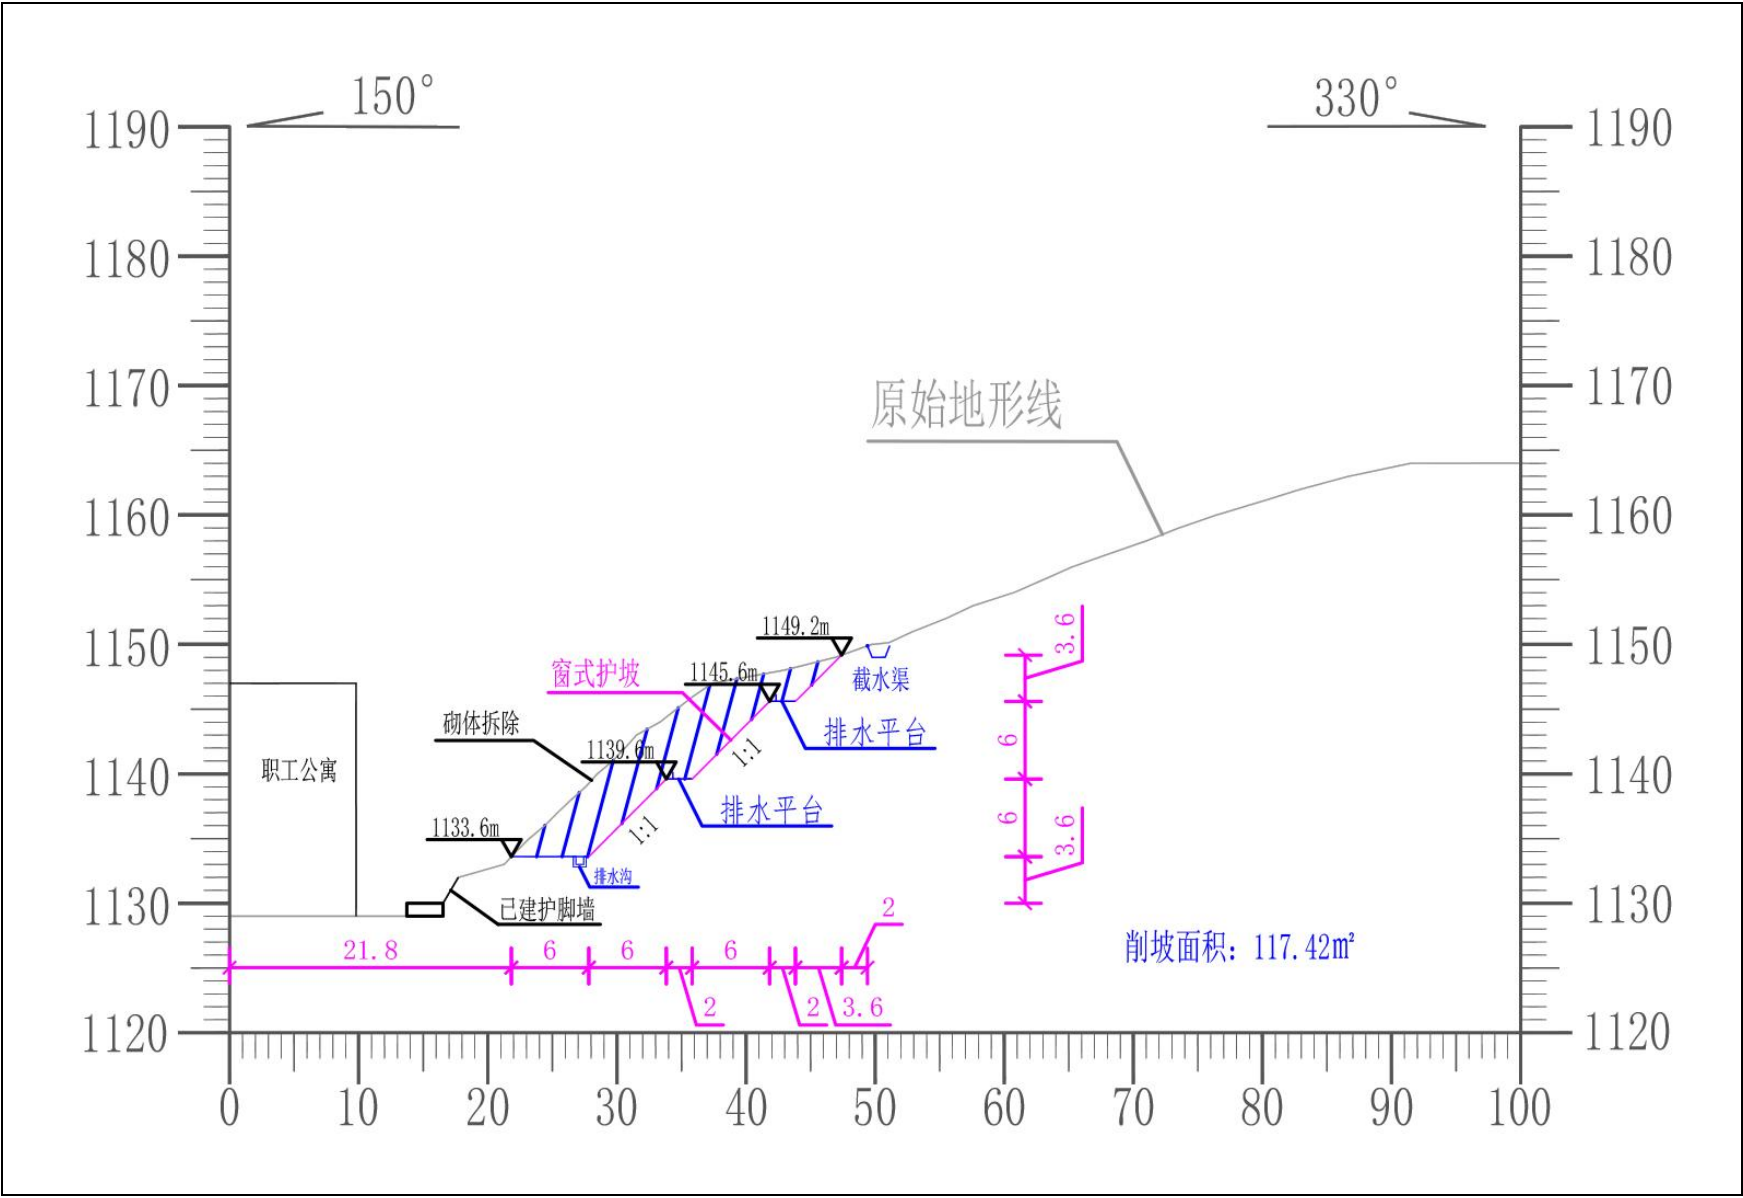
不稳定斜坡 BP1 治理工程平面设计图（4-4' 剖面）
